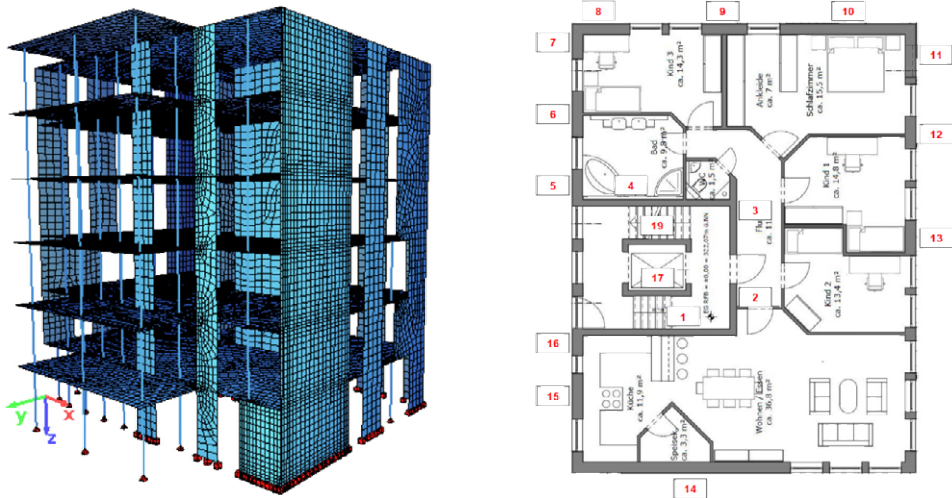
Finite-Elemente-Modell des betrachteten Gebäudes (links) und Grundriss des Erdgeschosses (rechts) [Yankov 2010]
